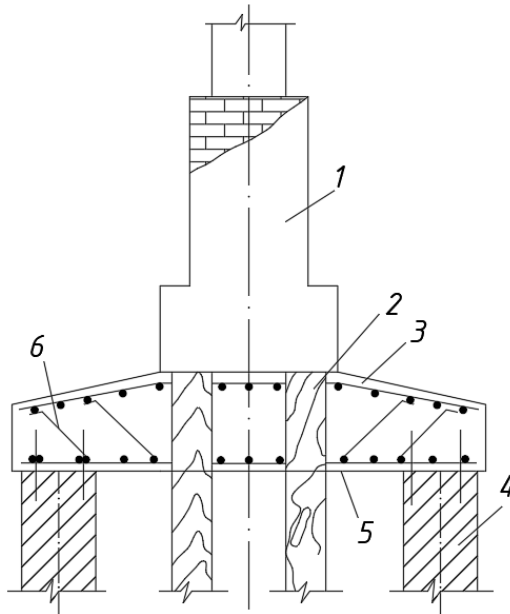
Підсилення стрічкового фундаменту палями з підведенням нового ростверку: 1 - підсилений фундамент; 2 - існуючі палі; 3 - ростверк підсилення; 4 - палі підсилення; 5 - арматурні сітки; 6 - відігнуті стержні
